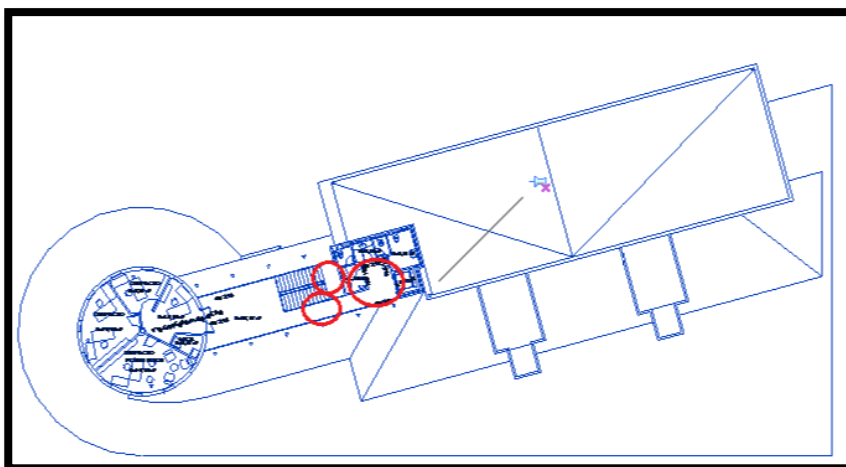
Zonas propuestas del láser escáner en la Segunda Planta.
